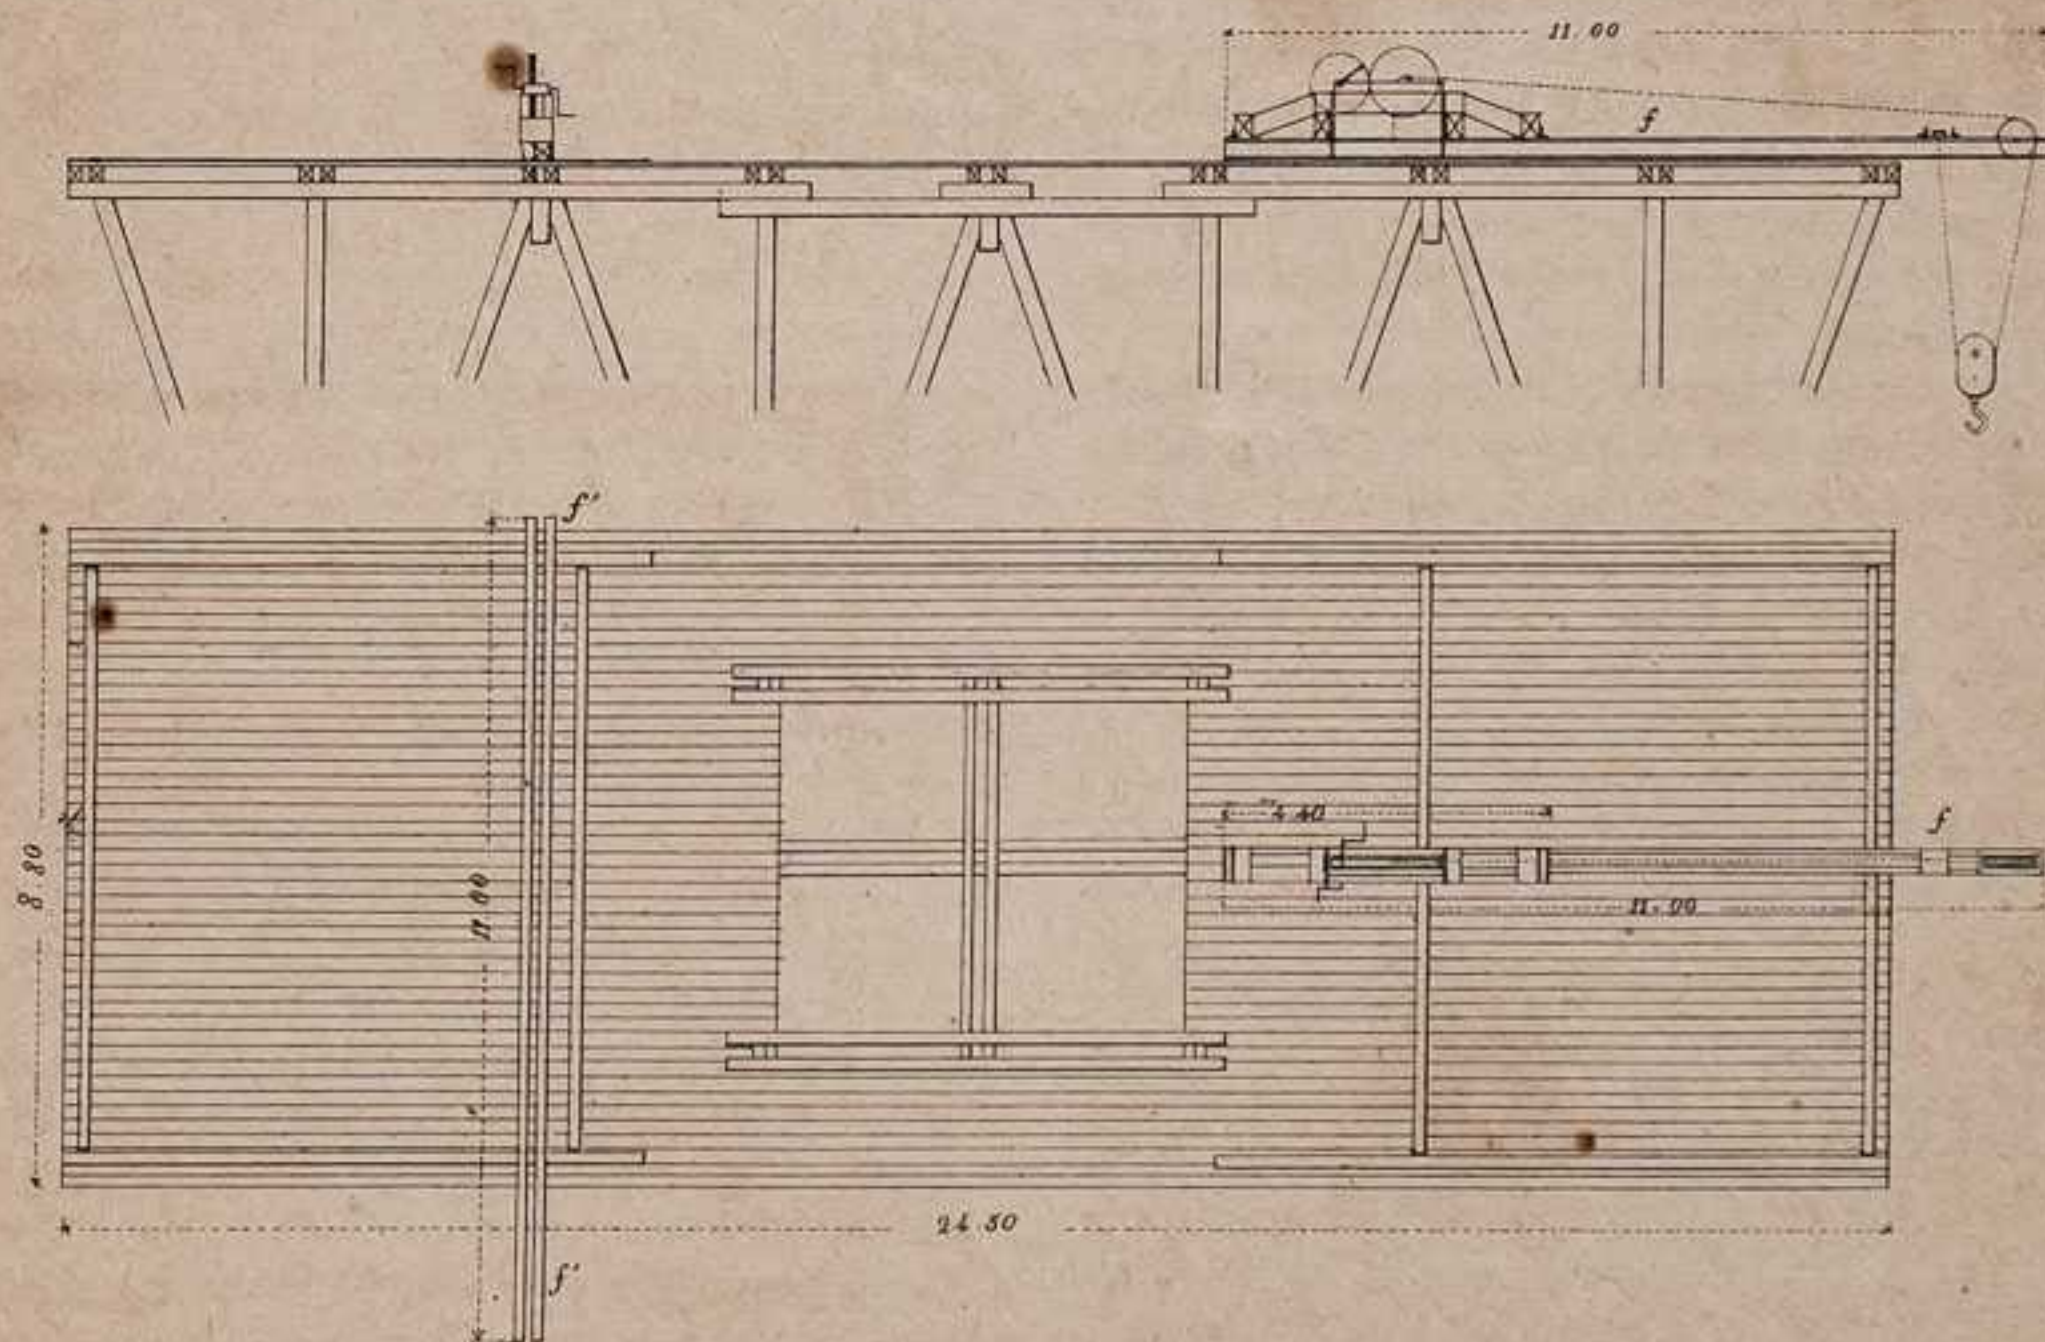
Disposizione particolare sull'impalcatura delle braccia di direzione coi verricelli e catene di sollevamento. Scala di 0<sup>m</sup>006 p. metro.
